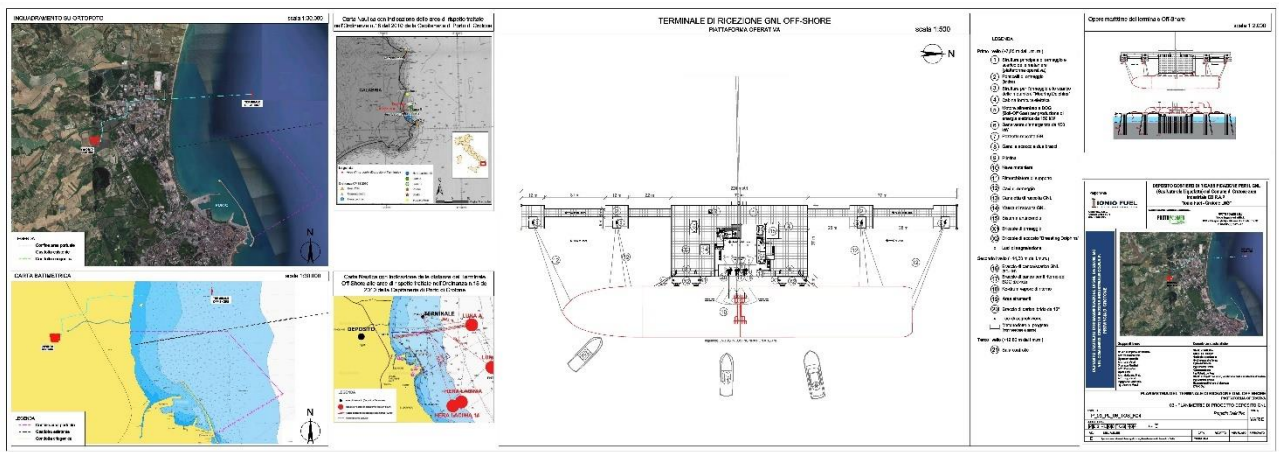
P_03_PL_06_TOS_R04 - Planimetria generale del Terminale di ricezione GNL Off-Shore
